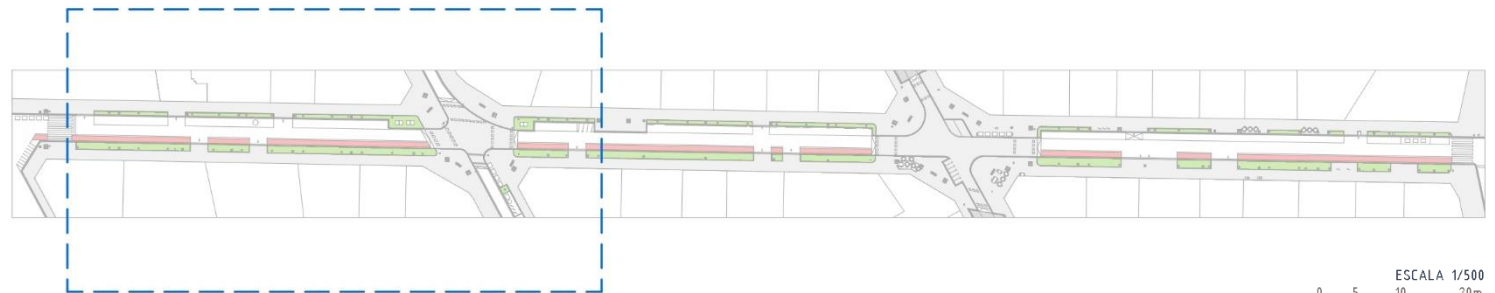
Plano de elaboración propia de las estrategias de mejora implementadas en el cruce de la Calle Sorní con la Calle Conde Salvatierra. E 1/2000m.
